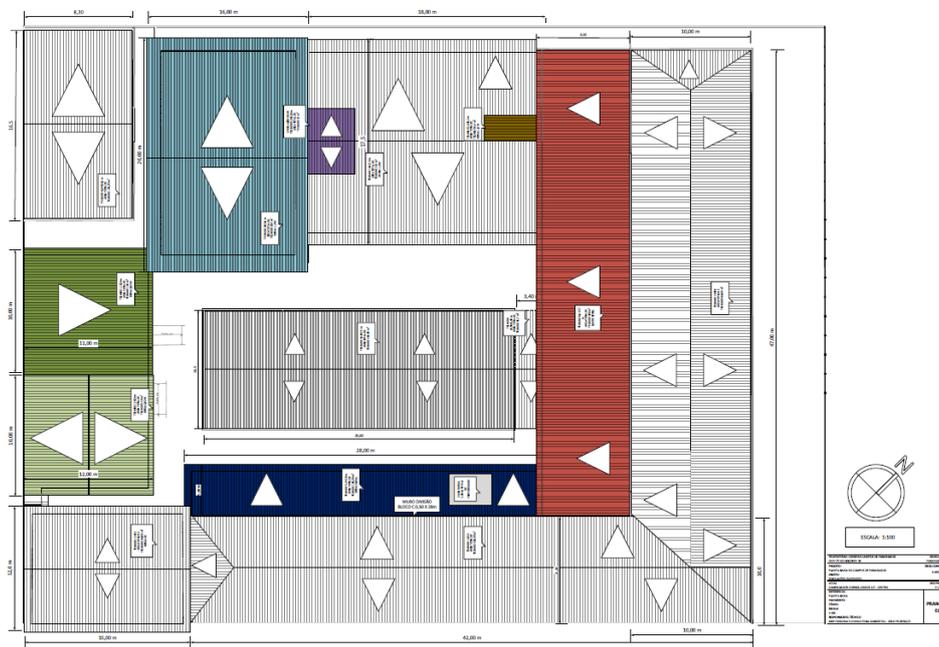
relação das edificações do Campus dimensões e áreas (Pranchas do Levantamento Arquitetônico – Planta de cobertura) – destaque para as edificações com substituição do telhamento
